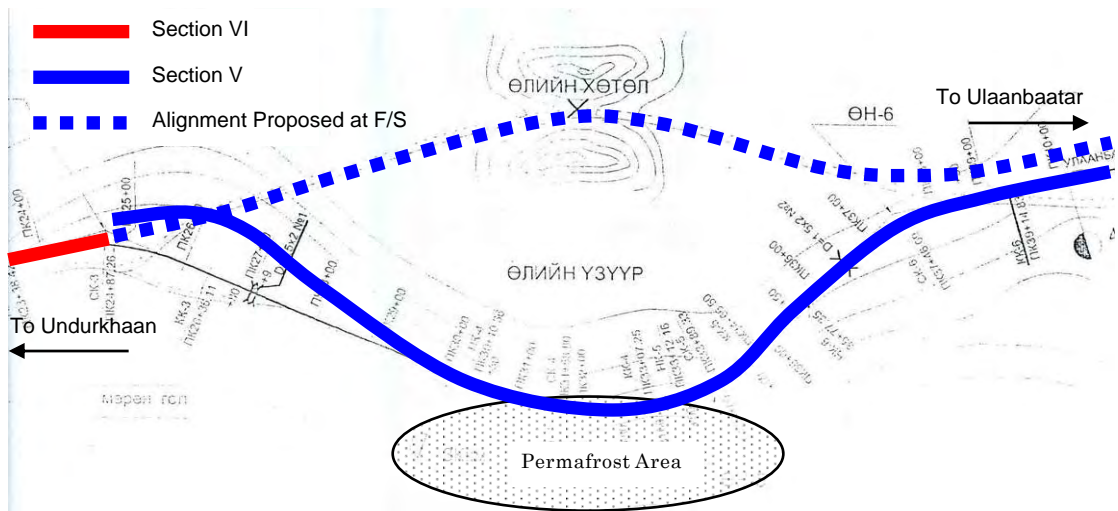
Section V、施工中の線形と F/S 調査時に提案した線形
